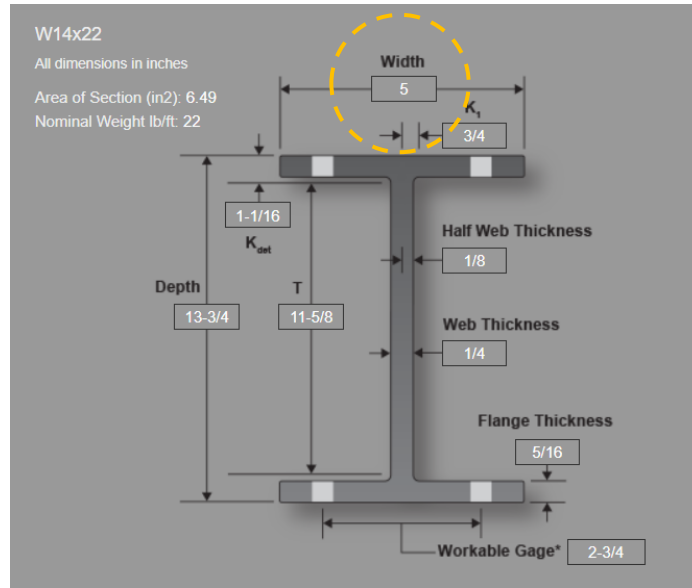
Perfil de acero 14\*22. Fuente: American Institute of steel construction; Herramienta de diseño de acero estructural.
